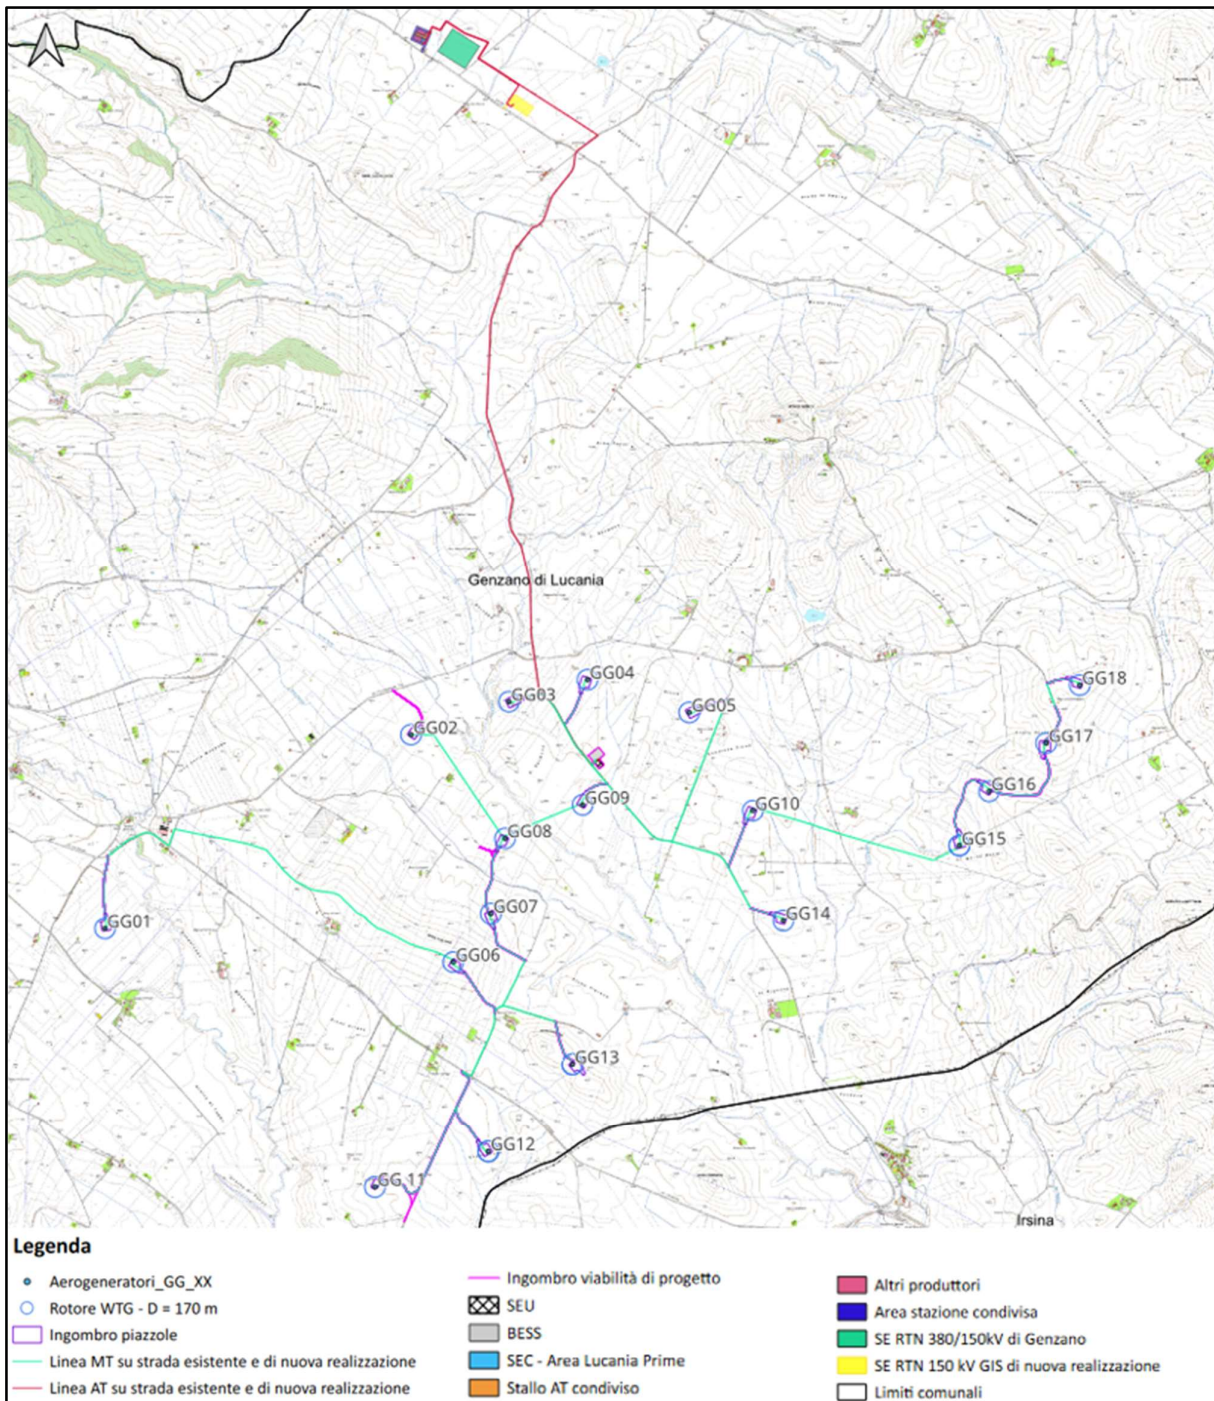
Layout d’impianto con viabilità di progetto su CTR
